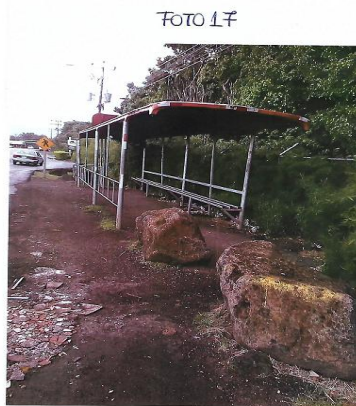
subespecie de estación de autobús vista lateral, donde se aprecia que no tiene un planché de concreto, no tiene iluminación, ni tiene rampas de acceso de entrada o salida.
